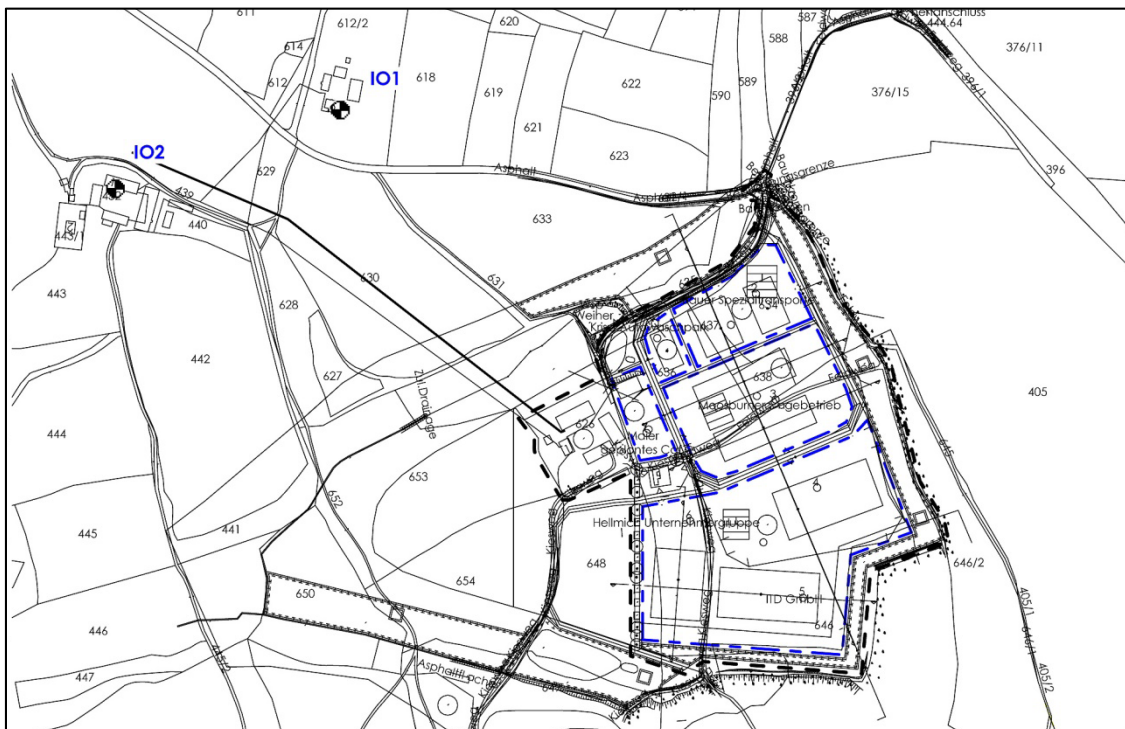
Lageplan mit Eintragung der maßgeblichen Immissionsorte (IO)
